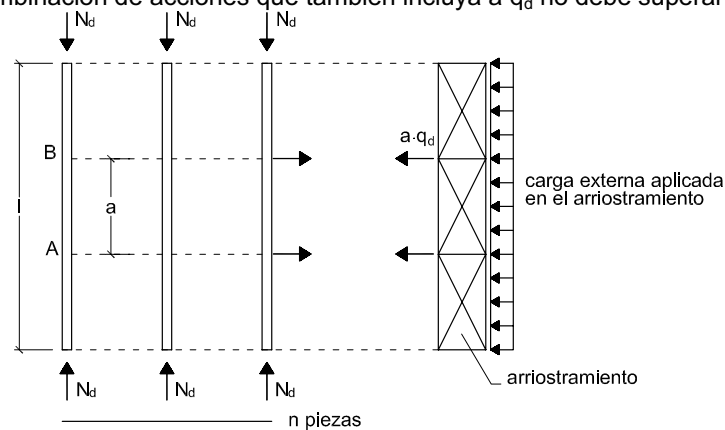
Sistema de vigas o cerchas que requieren restricciones laterales
